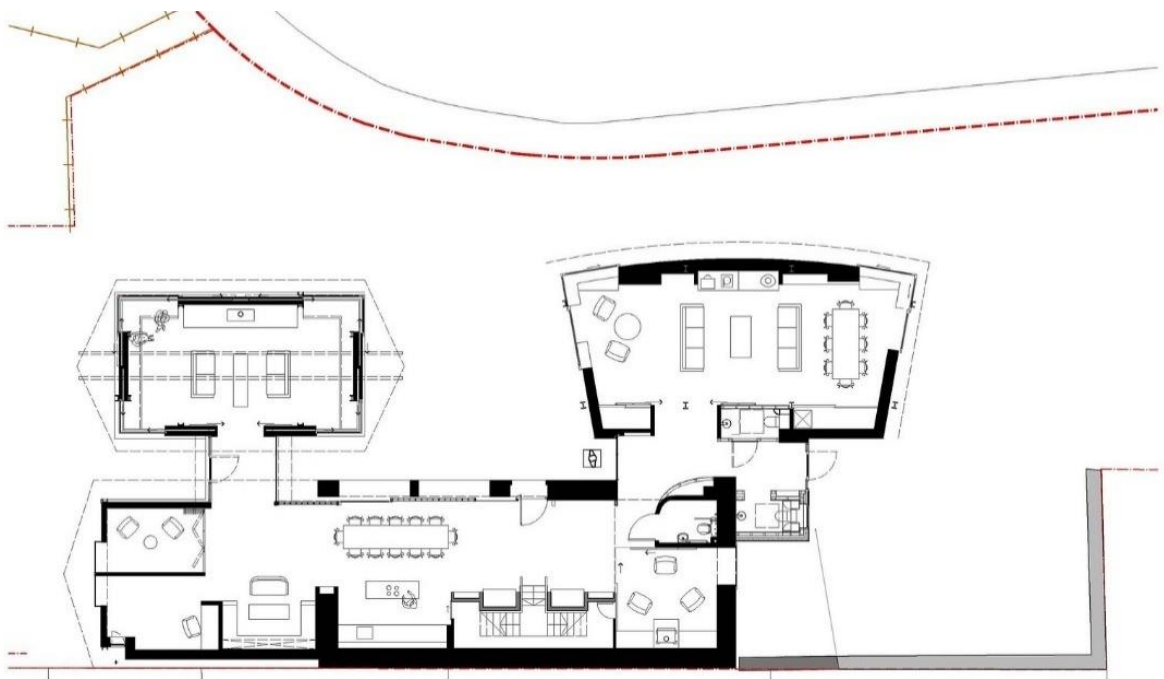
Planta Baixa Pavimento Térreo Maggie's Center Edinburg - Projeto de Richard Murphy Architects- Fonte: <https://www.richardmurphyarchitects.com/Maggies-Cancer-Caring-Centre-Edinburgh> - acessado em 05.05.2023
